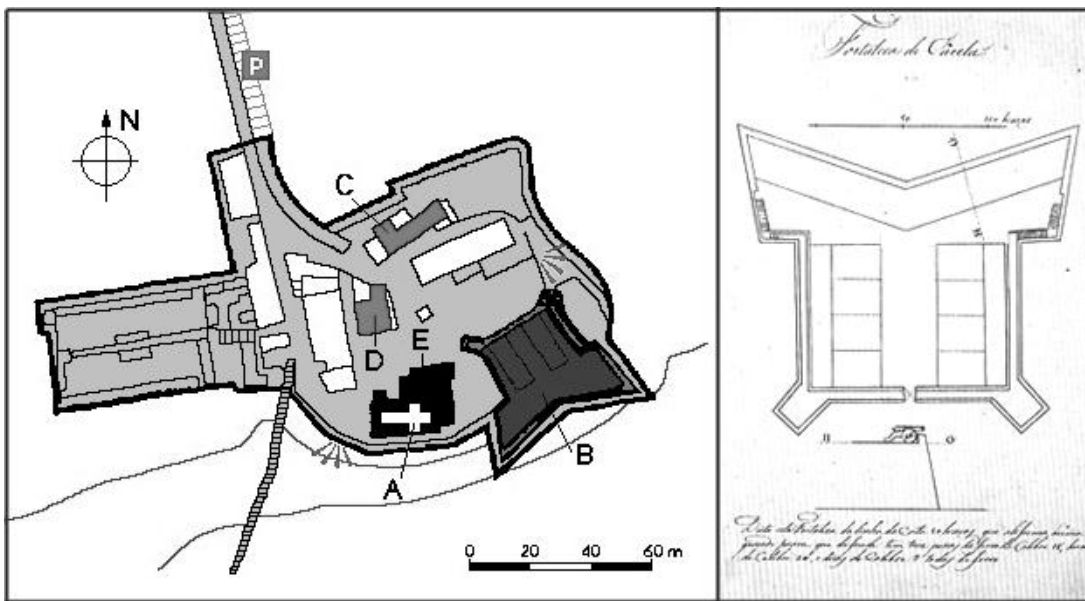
Planta do povoado e planta da fortaleza²⁰
